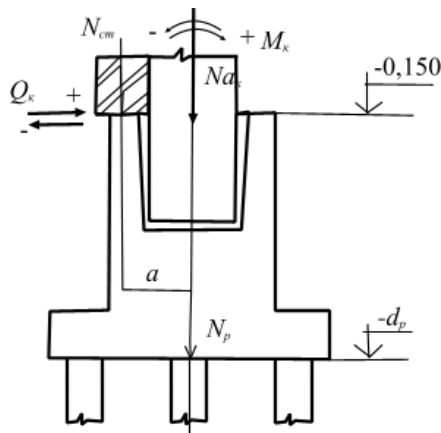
Схема приведения нагрузок к подошве ростверка
